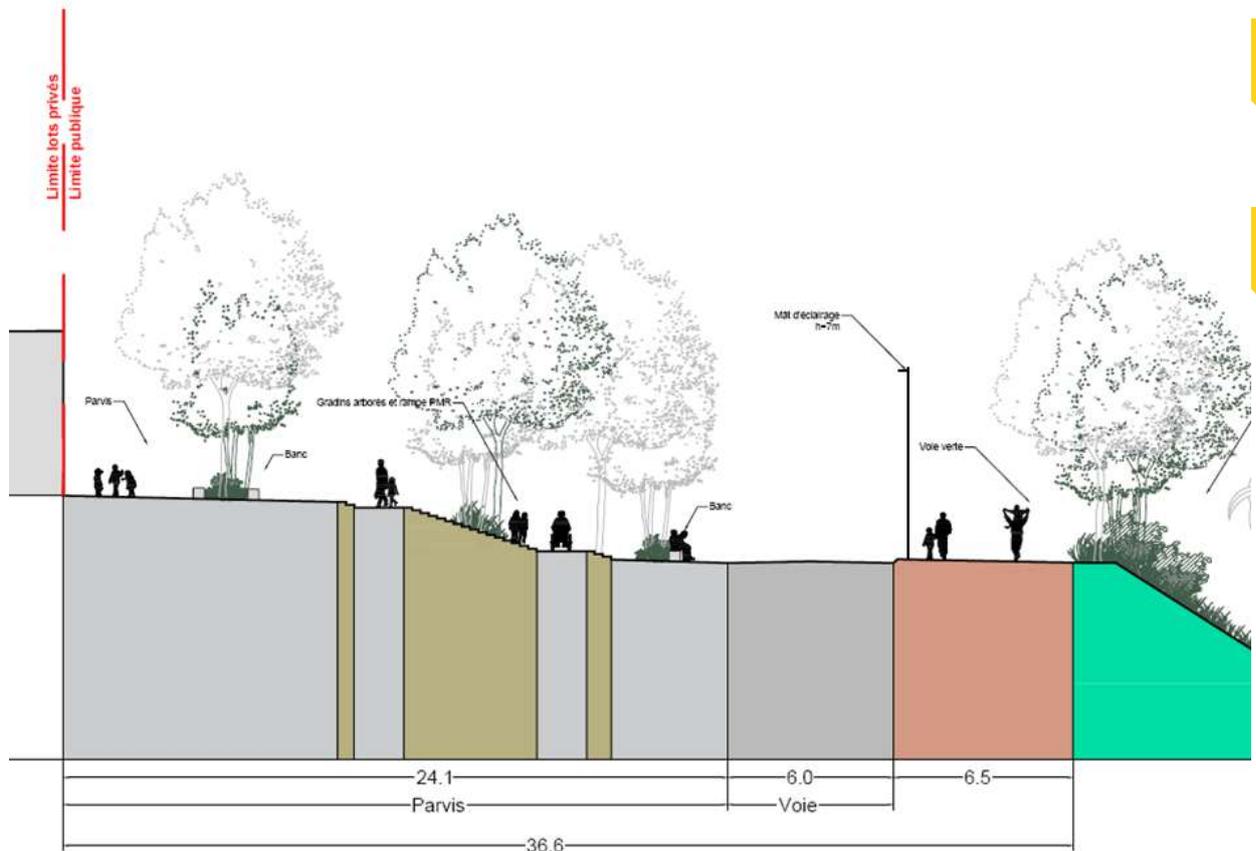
La rue de la carrière, profil C entre coteaux et village (au droit place publique)
